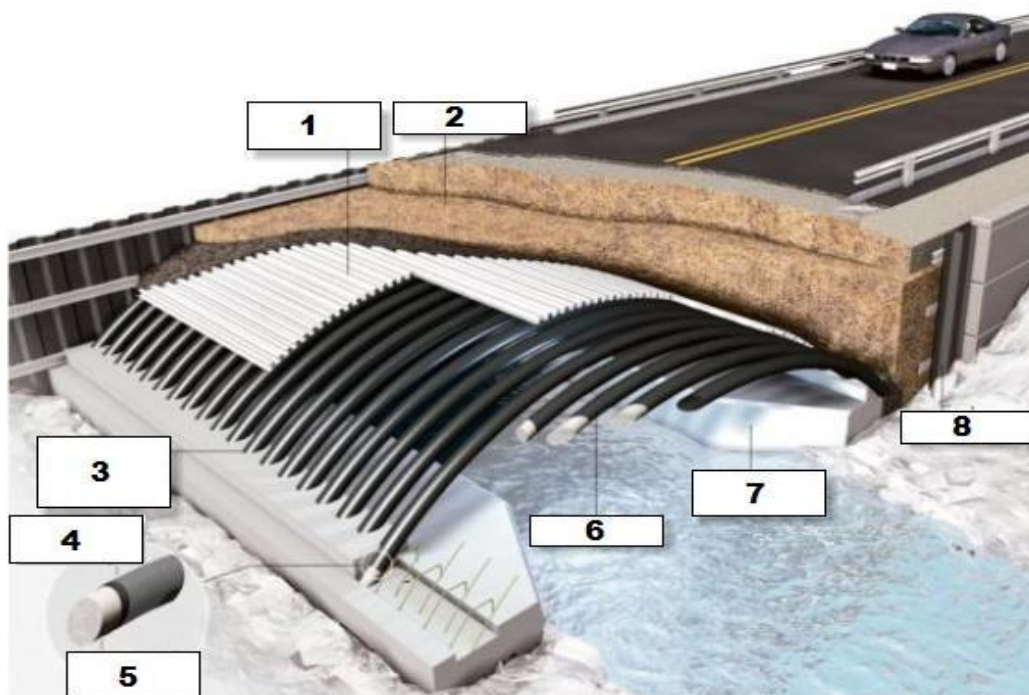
Арочный мост с несущими элементами из заполненных бетоном арок из композитного материала: 1 - гофрированные листы из композитного материала; 2 - грунтовая засыпка; 3 – концы труб, заделанные в бетонный фундамент; 4 - композитная оболочка трубчатой арки; 5 – бетонное ядро; 6 – арки; 7 – бетонный фундамент; 8 – оголовок [4]
